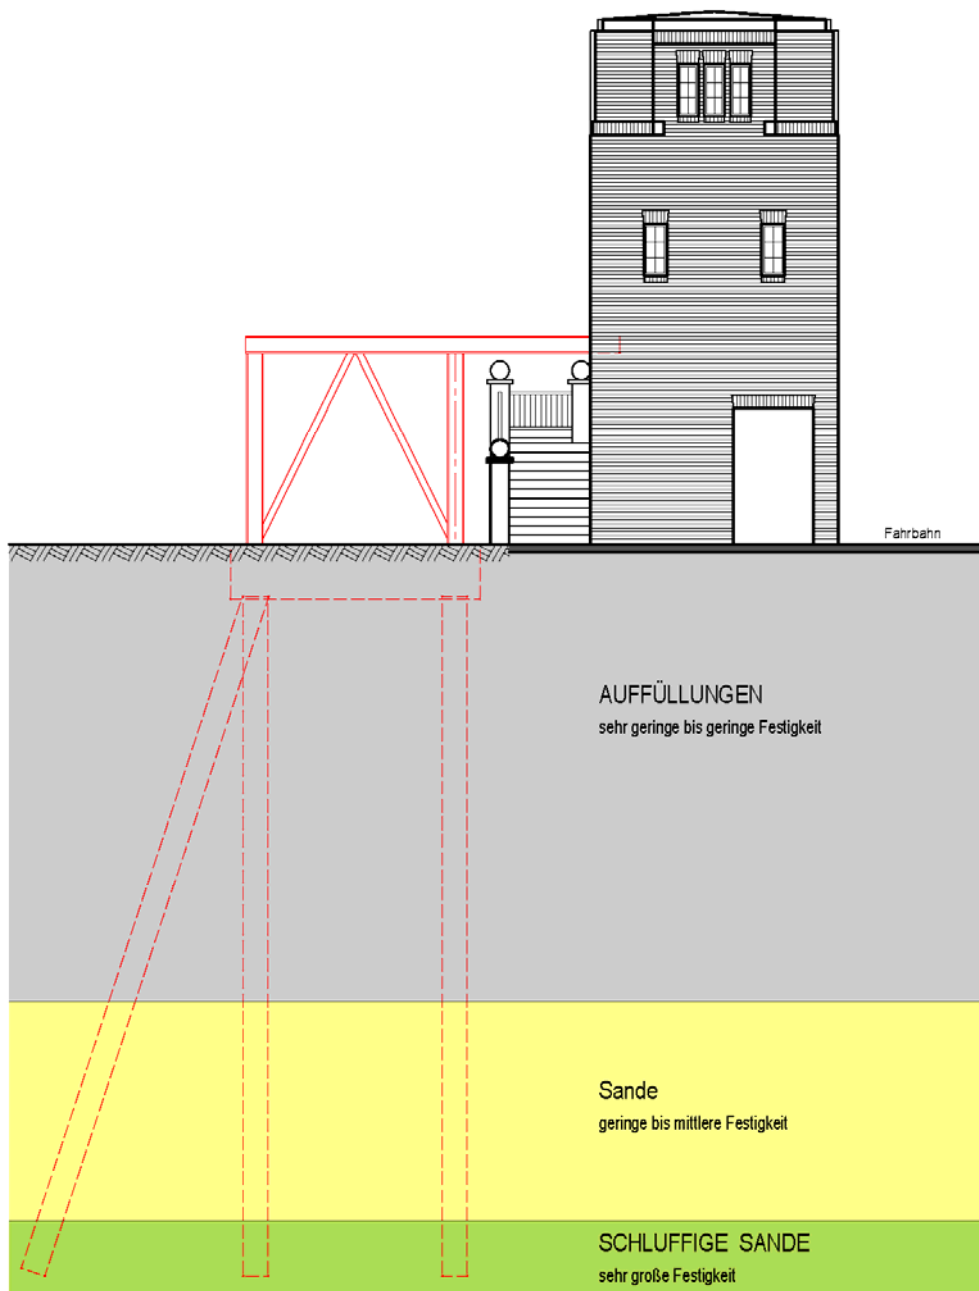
Turm mit außenliegender Stahlkonstruktion
